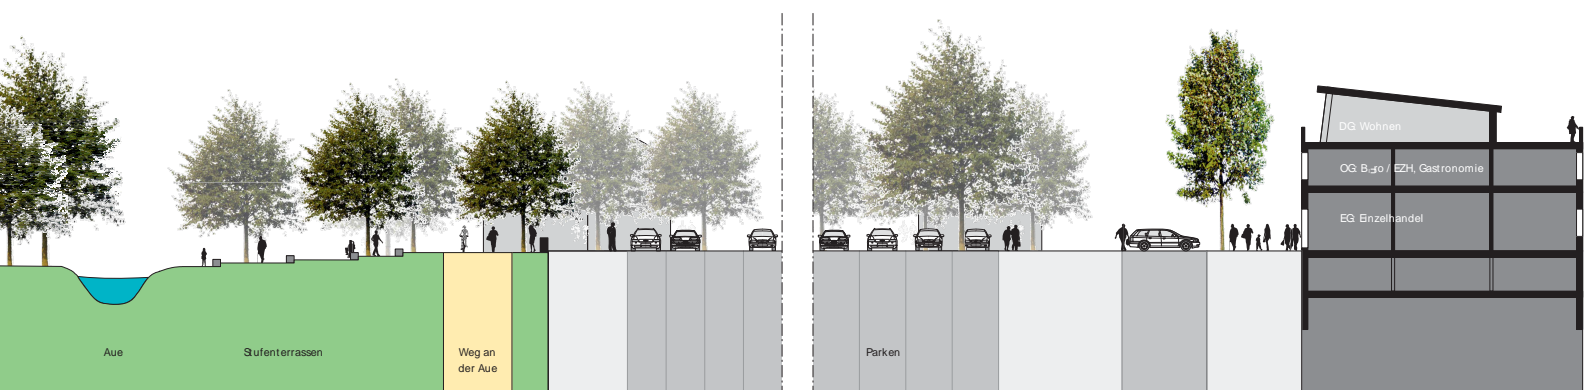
/5 Schnitt mit Blick nach Westen [ohne Maßstab]
